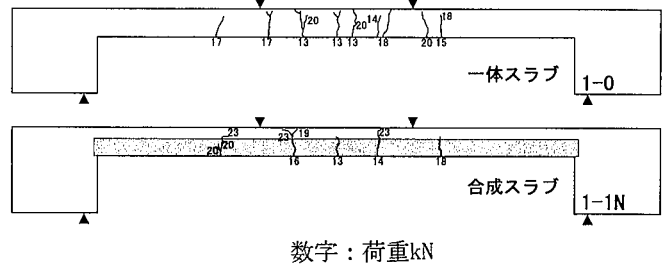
単純支持試験体 ひび割れ状況
